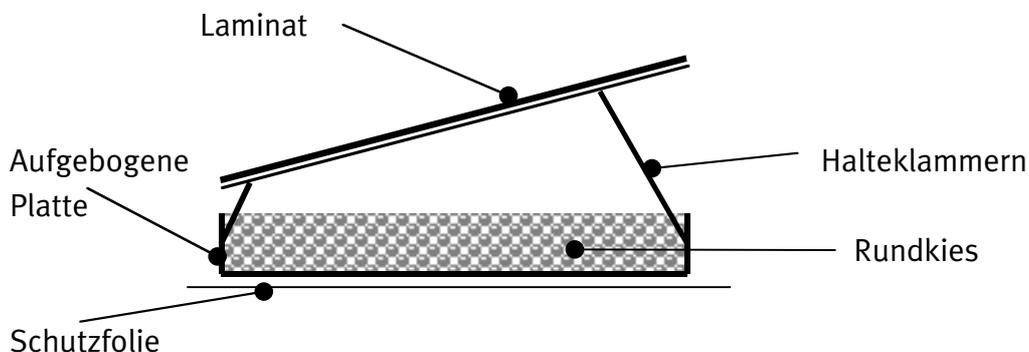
Ansicht der SOLight-Variante, welche mit einer aufgebogenen Platte fundiert wird, an welcher Halteklammern für das Solarmodul befestigt werden.
